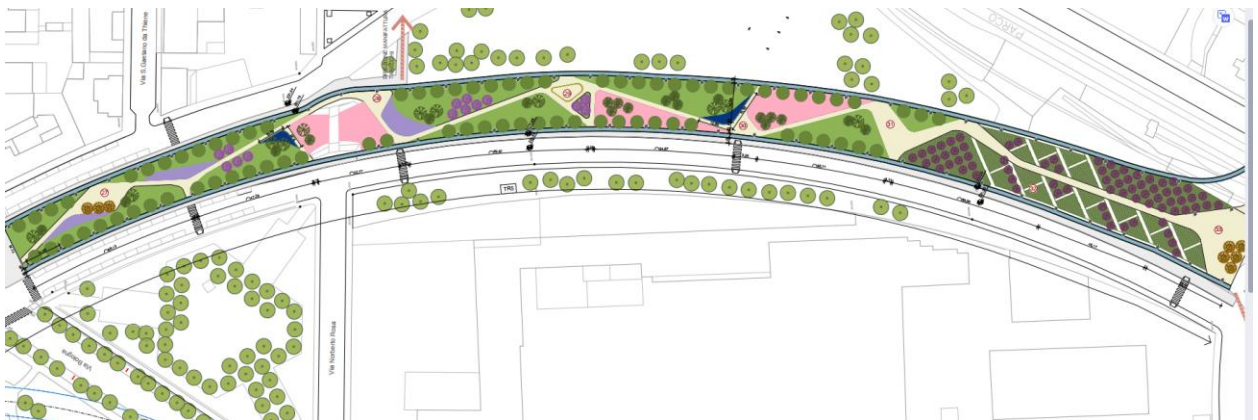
Planimetria TR5 tra via Bologna e via Monteverdi
